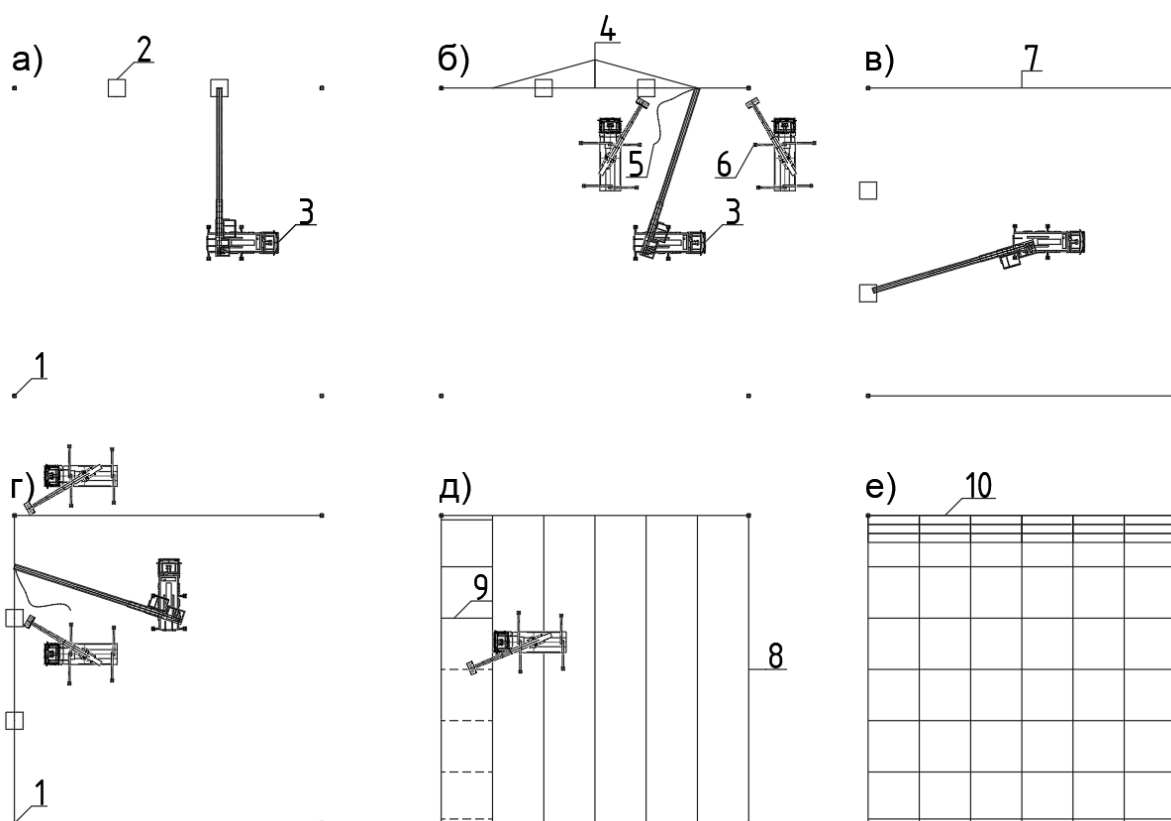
Монтаж отправочными марками без предварительного укрупнения: а – монтаж временных опор подстропильной фермы; б – монтаж отправочных марок подстропильной фермы; в – перестановка временных опор; г – монтаж отправочных марок стропильной фермы; д – монтаж прогонов и связей; е – монтаж стального профилированного лист; 1 – колонна; 2 – временная опора; 3 – автомобильный кран; 4 – отправочная марка; 5 – оттяжка; 6 – автогидроподъемник; 7 – укрупненная подстропильная ферма; 8 – укрупненная стропильная ферма; 9 – прогон; 10 – профилированный лист
